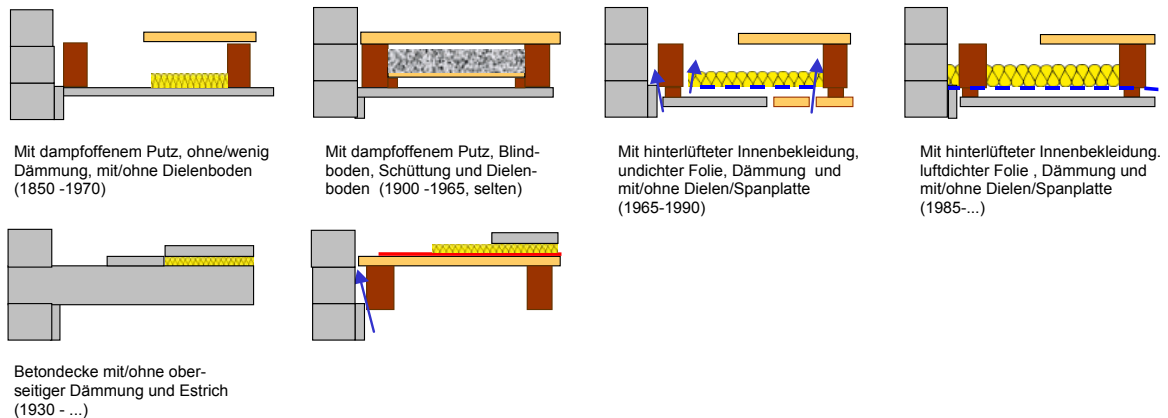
Kehlbalkendecken, Bauarten
